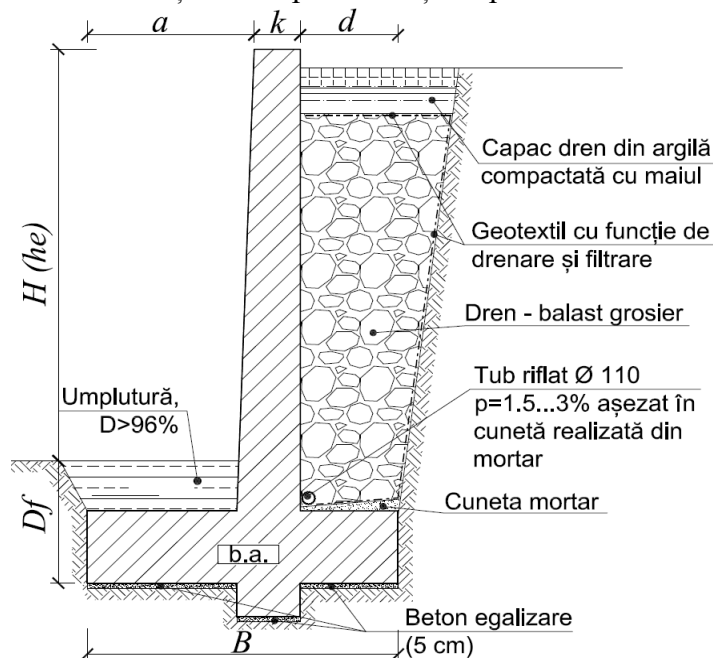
Secțiune transversală principală zid de sprijin din beton armat cu pinten sub elevație
